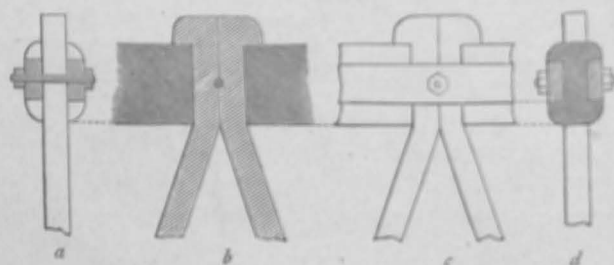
Wegebrücke bei Aubervilliers über den Kanal von St. Denis. Bauart NÉVILLE. 1845.
